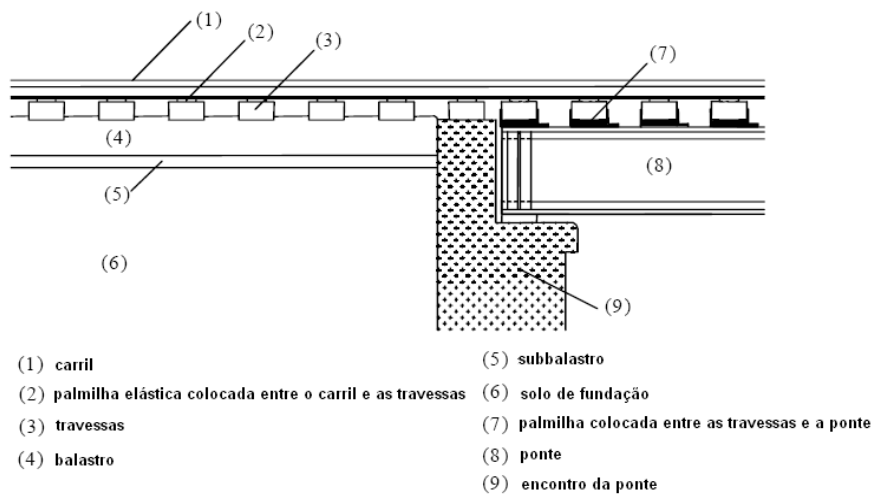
Perfil longitudinal da zona de transição (adaptado de Calçada, 1995)
